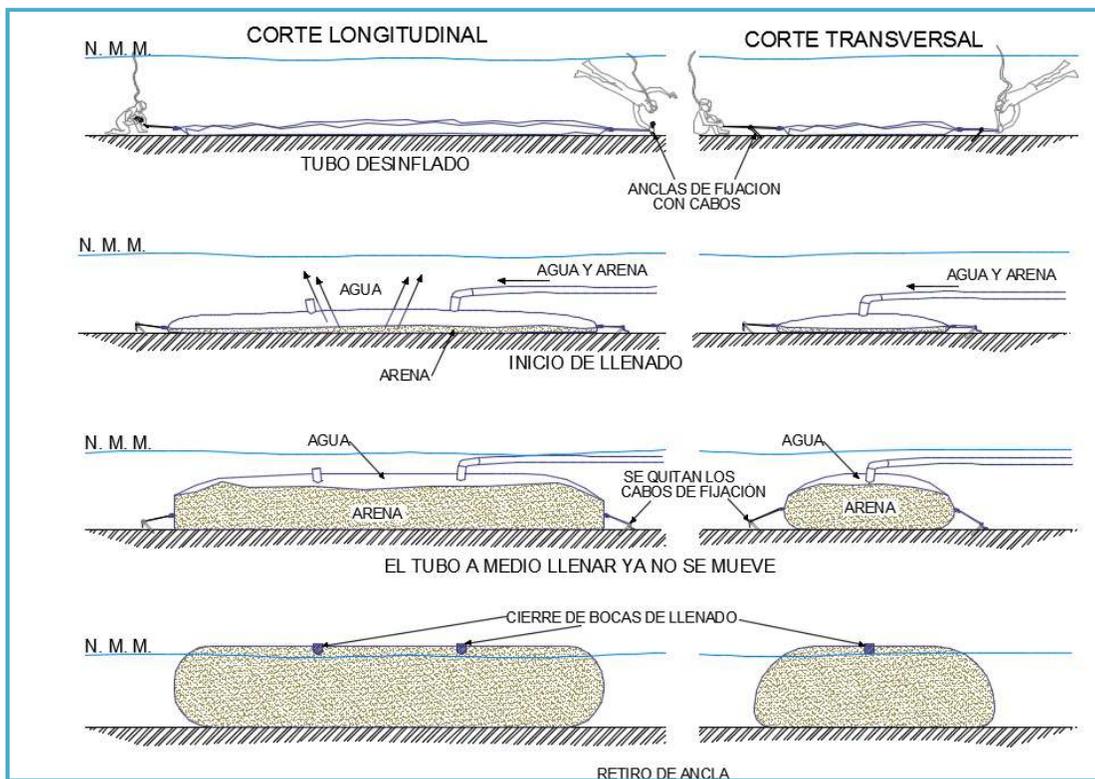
Proceso típico de llenado de los tubos de geotextil para la sección del muelle con refuerzo.
